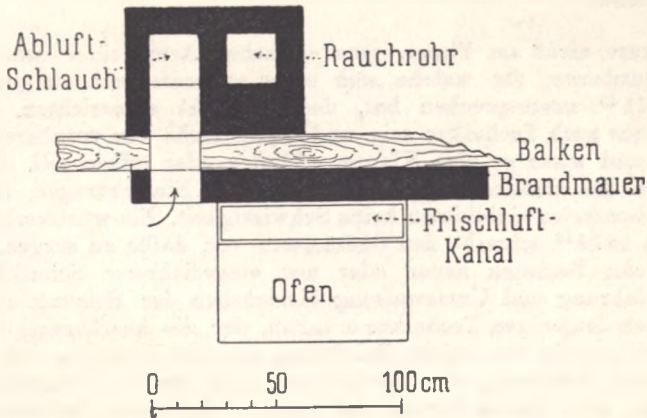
Ofenheiz- und Ventilationsanlage in einem hölzernen Landschulhause, nach den norwegischen Musterzeichnungen.
